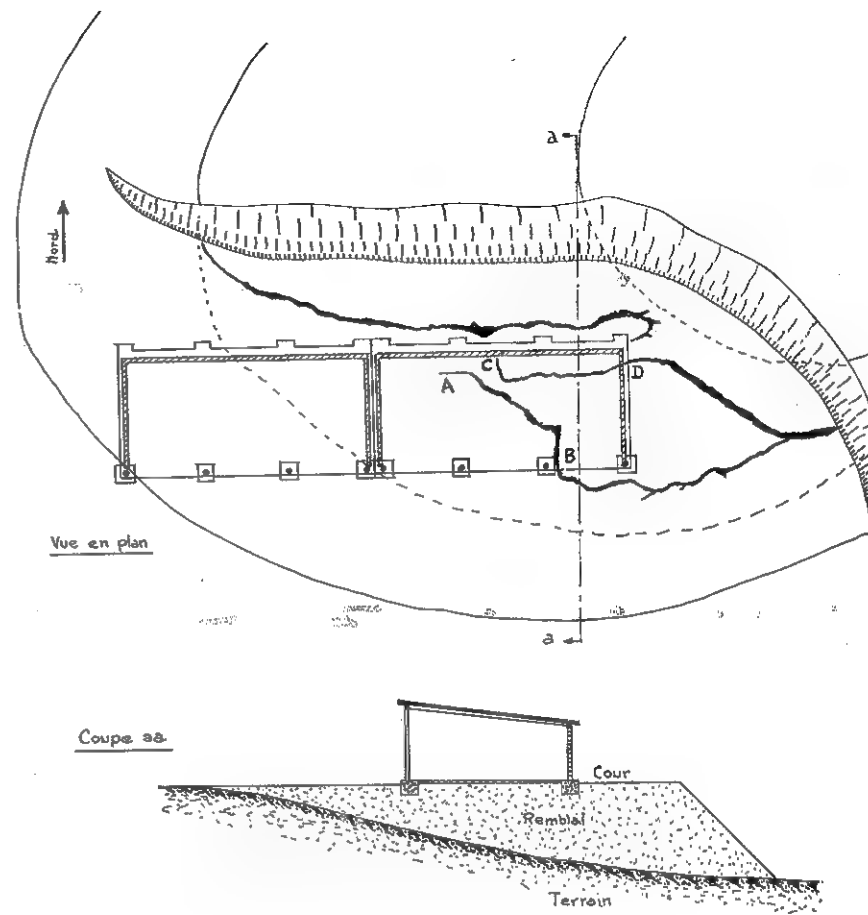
Effondrement d'un préau fondé sur un remblai.
